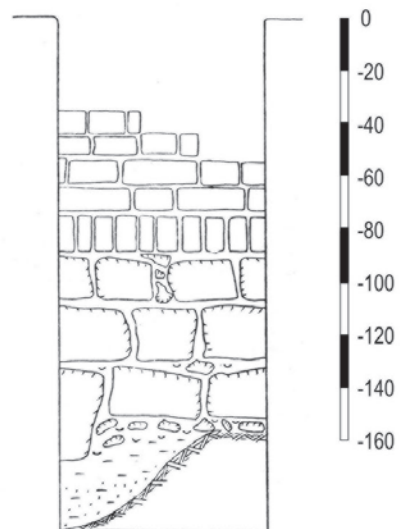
Богородице-Успенский монастырь. Треша 5. План. Западный и восточный фасады стены
